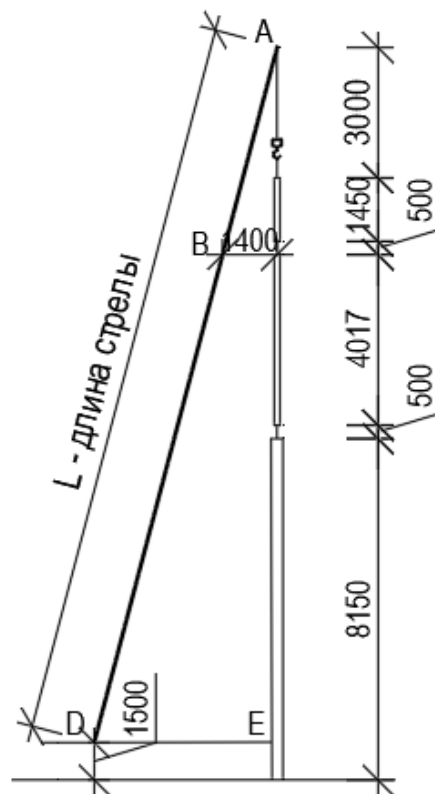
Схема к выбору крана для монтажа ферм покрытия
